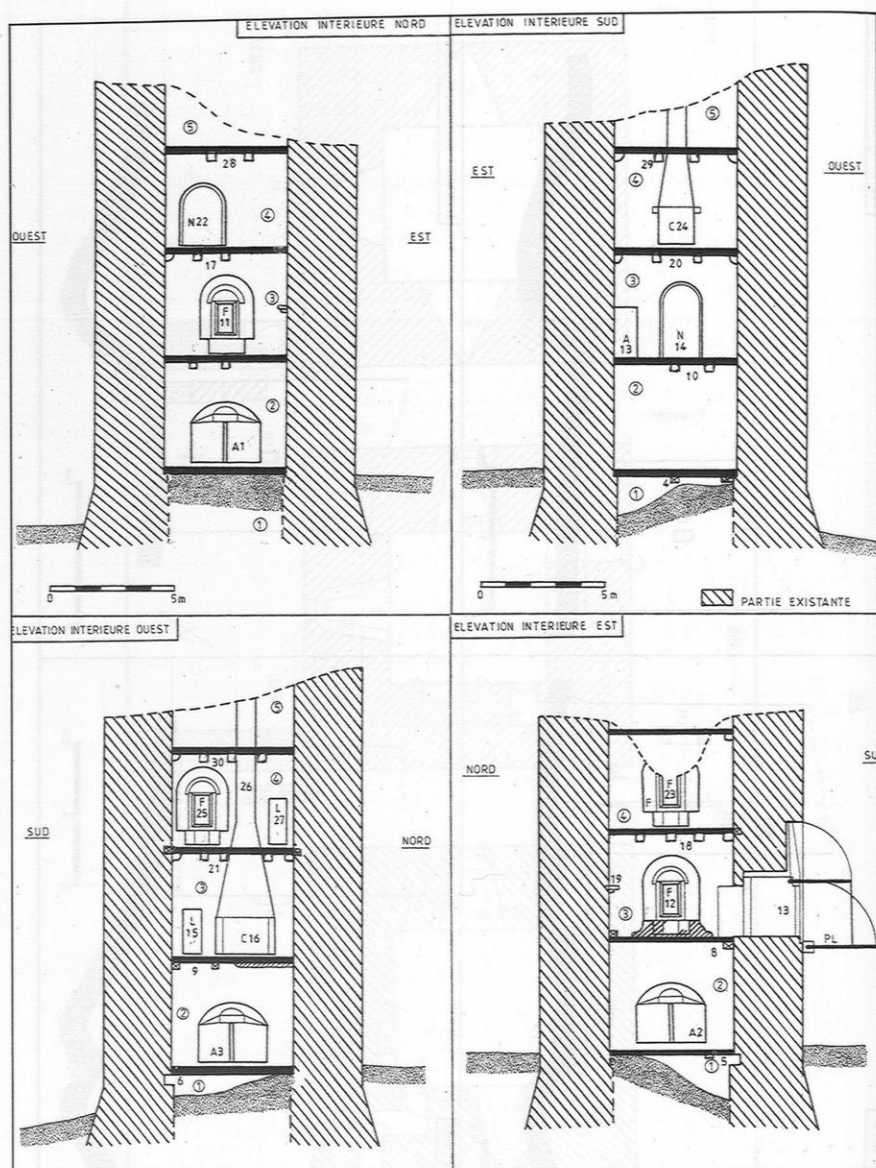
Tour carrée. Élévations intérieures. Pour la légende voir plan n° 3.
